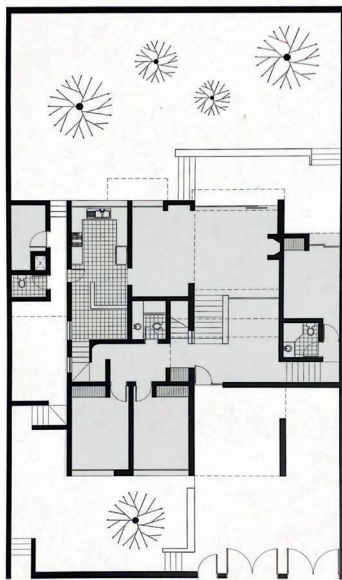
Casa Carrión, planta baja. Ecuador. Henry Carrión 1974.
